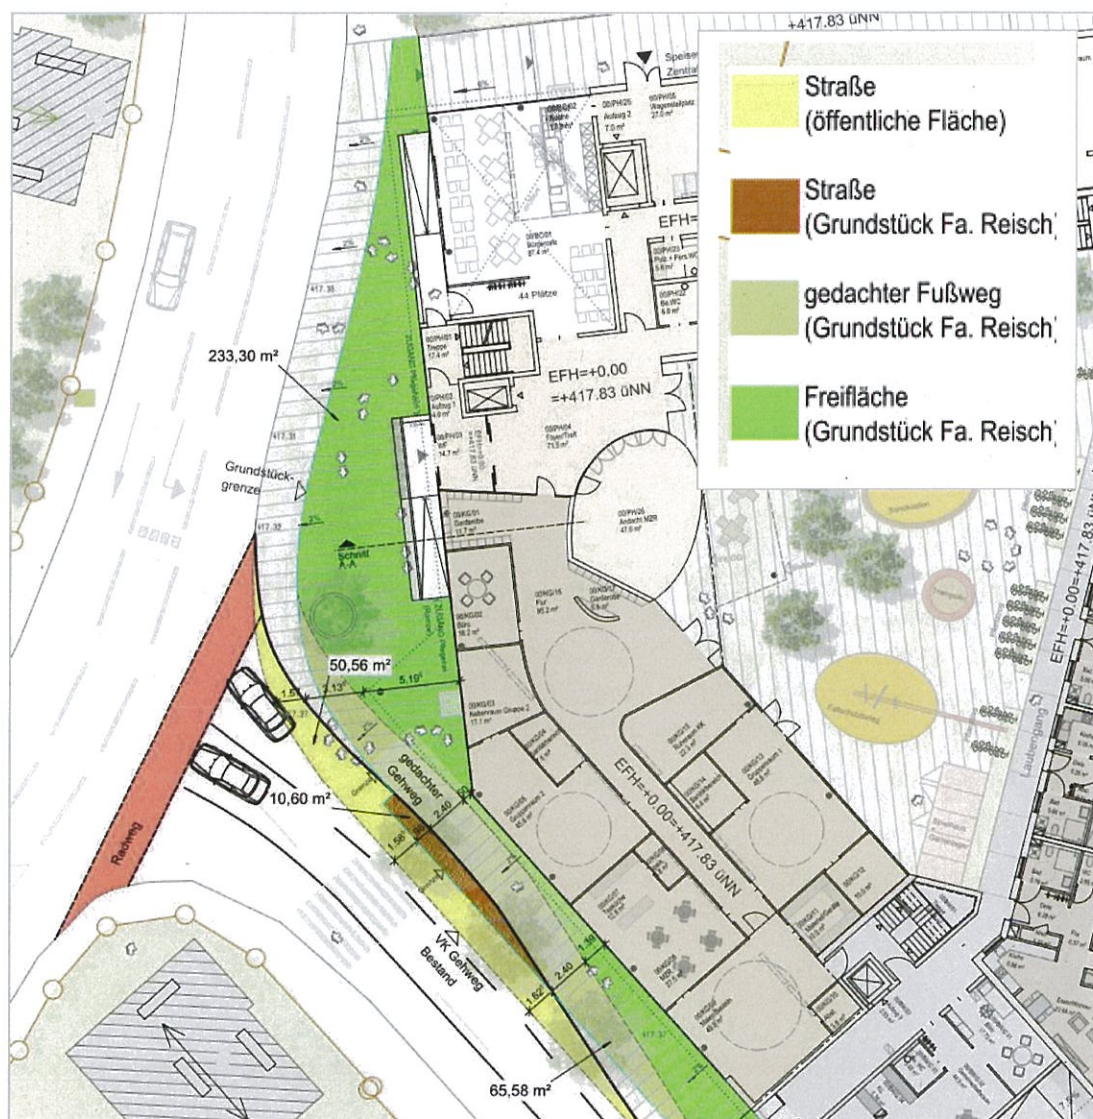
EG und Flächengliederung Eingangsbereich, Architektenwerkgemeinschaft „weinbrener.single.arabzadeh“, 02.09.2014
